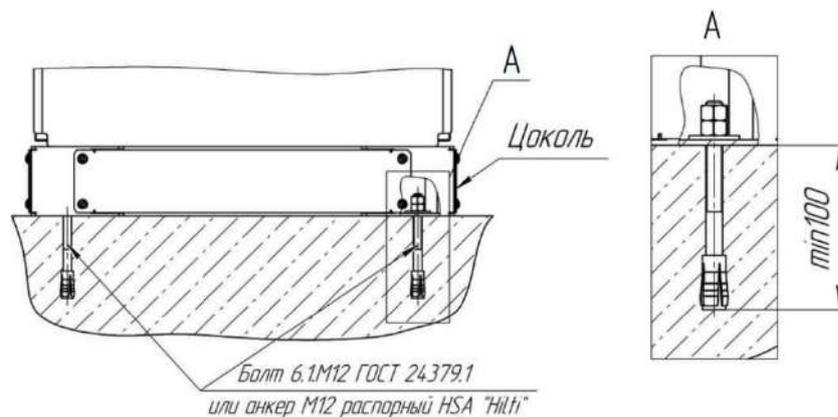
Вариант крепления ГРЩ с помощью анкерных болтов
